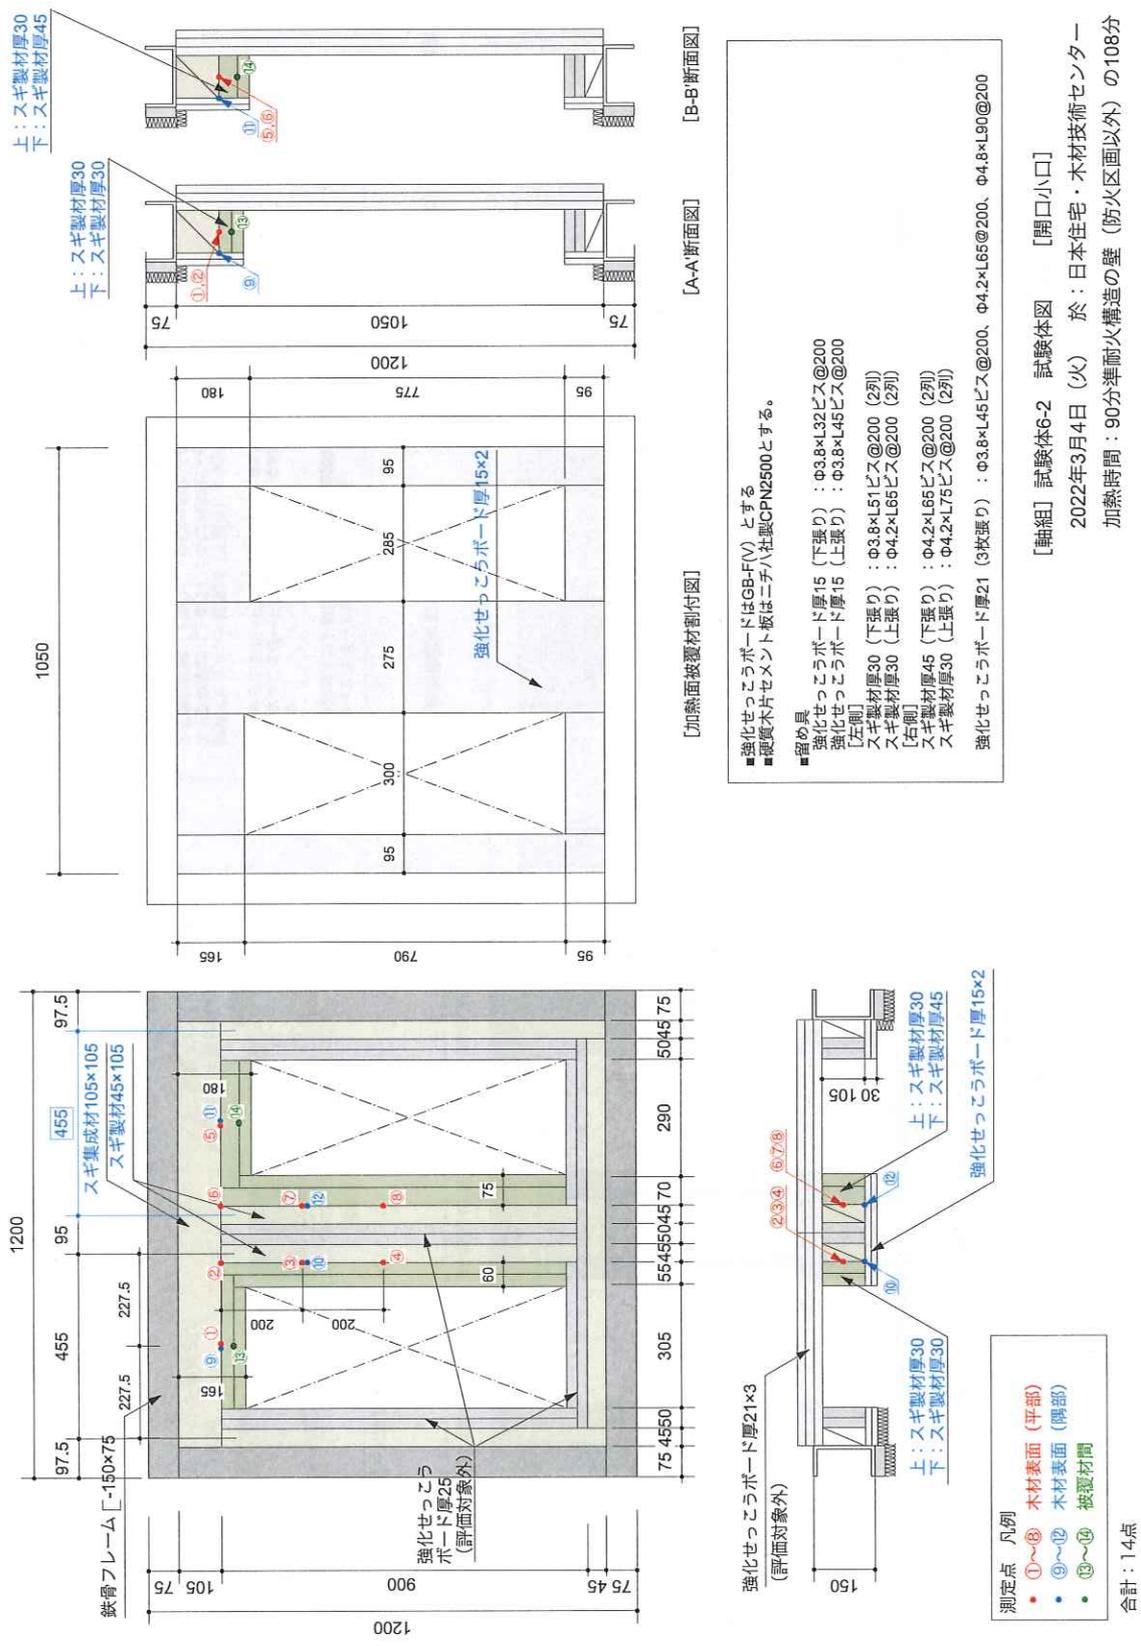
試験体の構造・寸法・熱電対配置 (試験体 6-2)
